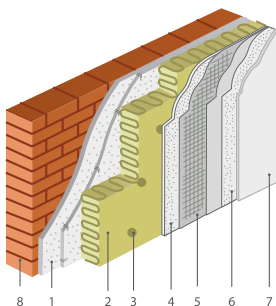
Система наружного утепления с тонким штукатурным слоем ROCKFACADE:
